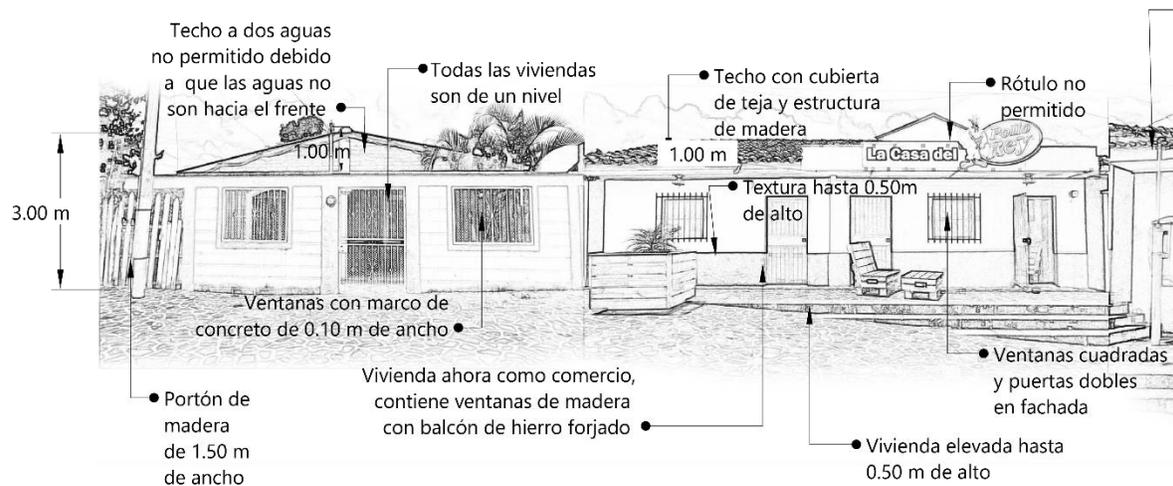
Perfil urbano de viviendas locales de adobe en Ojojona. Fuente: (Nieto & Trejo, 2017)
